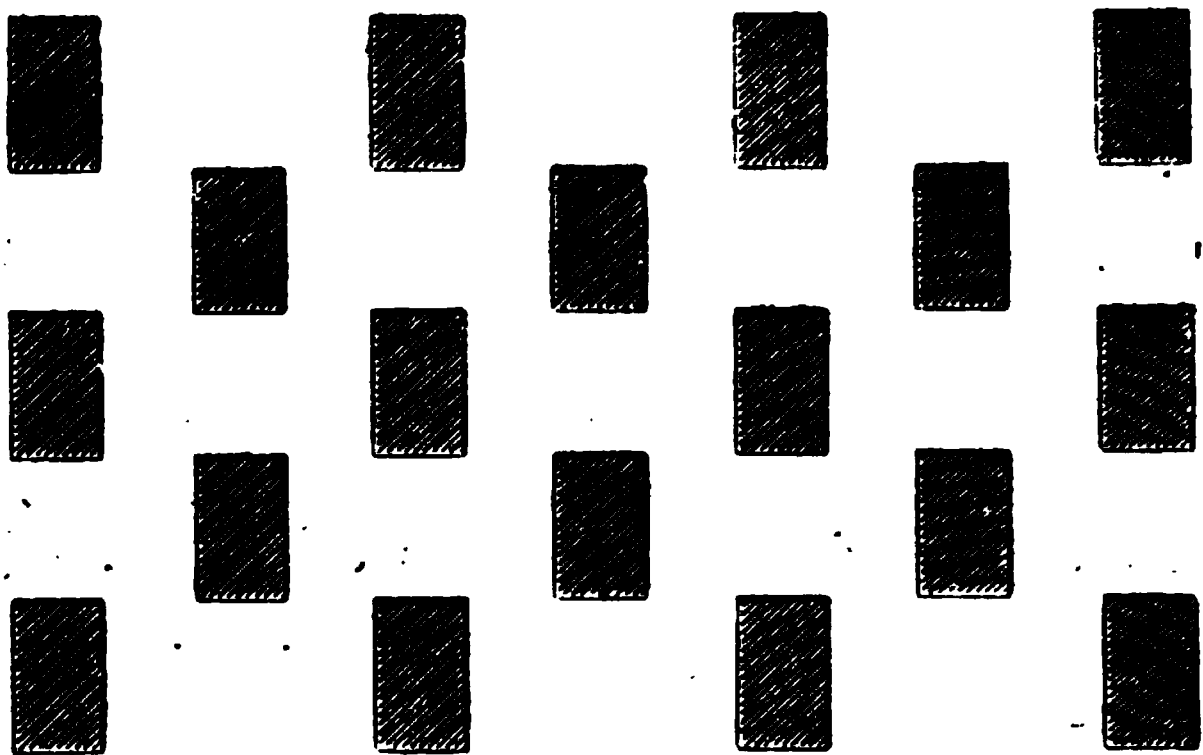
Piliers tournés. Quadrillage à simple voie (coupe horizontale).
